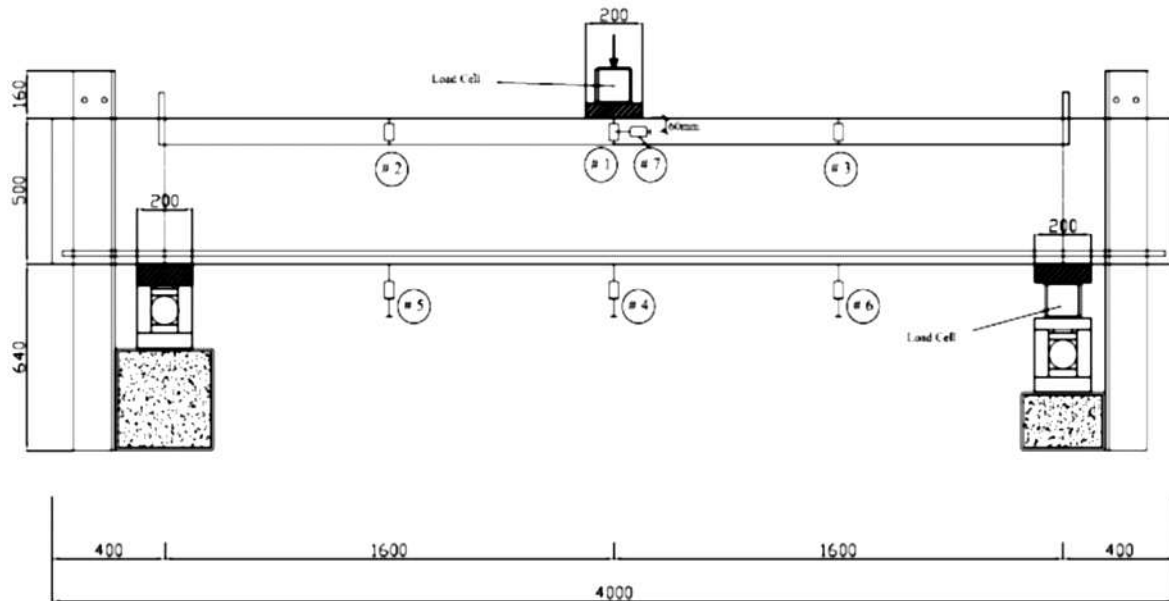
Sistema de ensaio das vigas (SAGASETA 2008)
